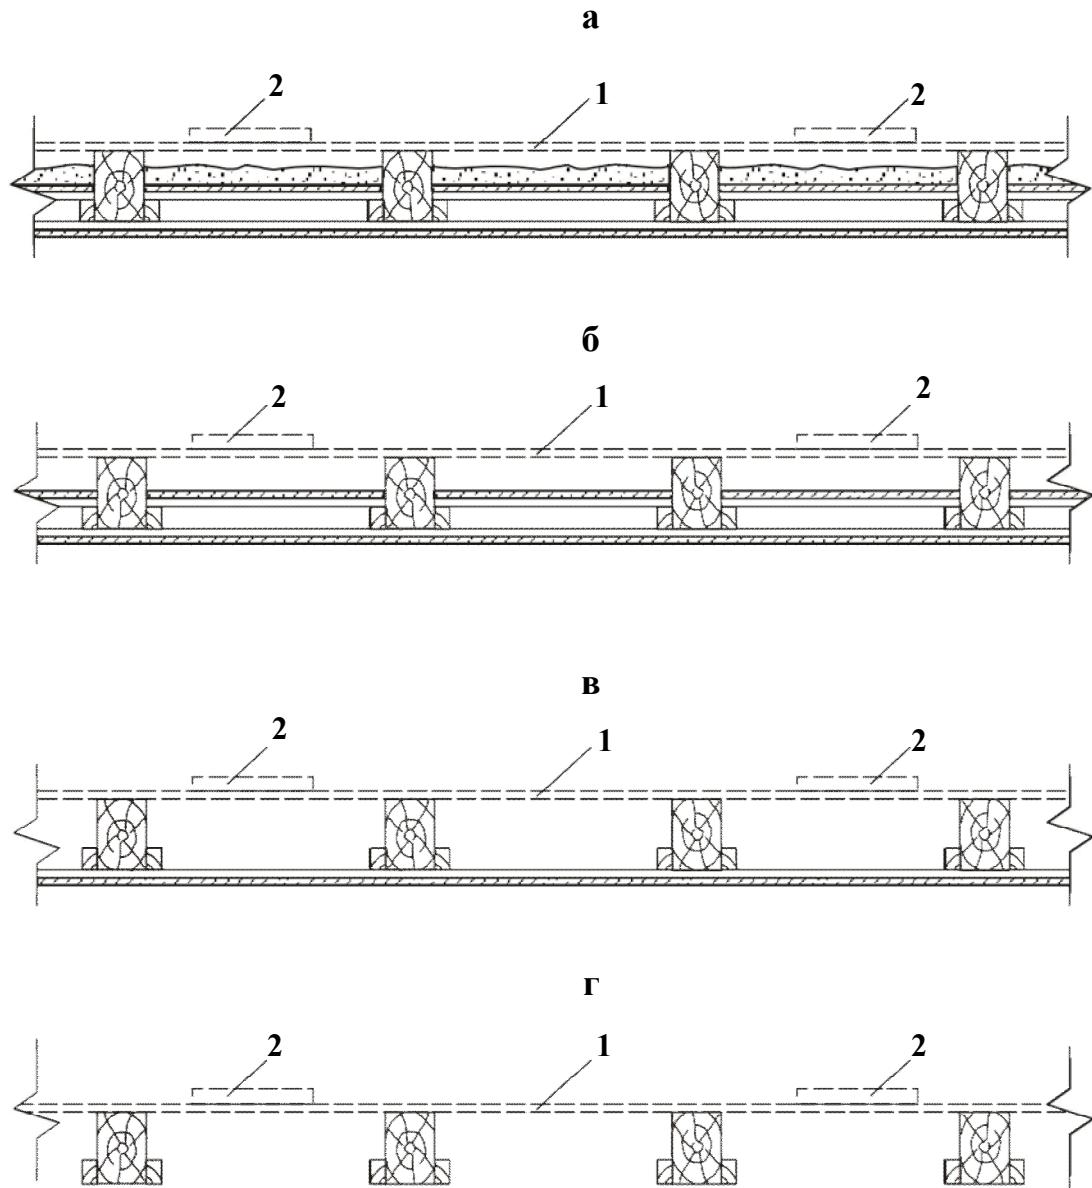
Послідовність розбирання дерев'яного перекриття:
